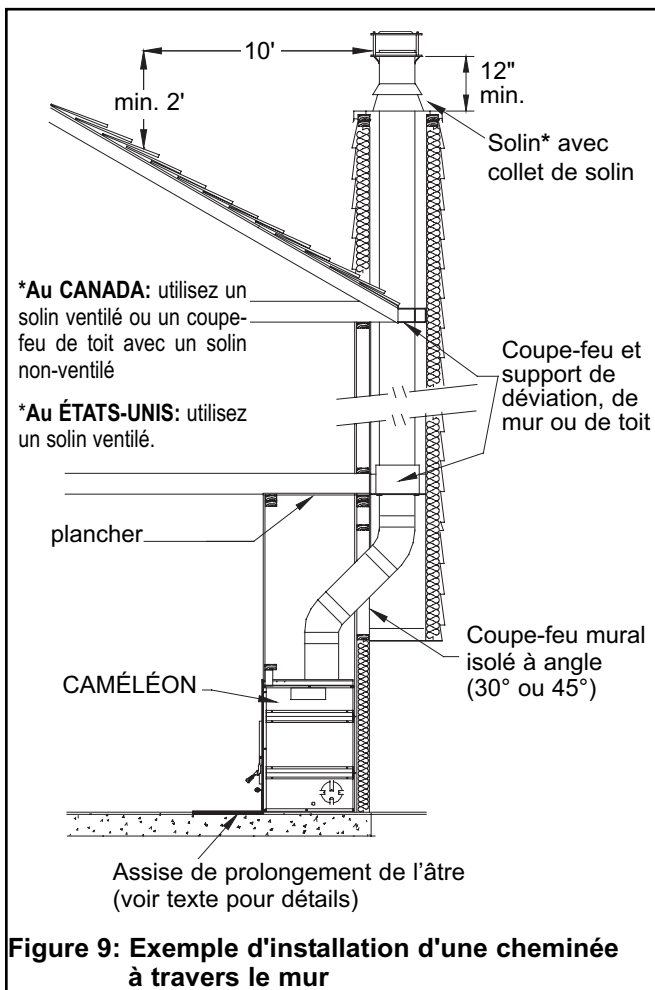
Exemple d'installation d'une cheminée à travers le mur
